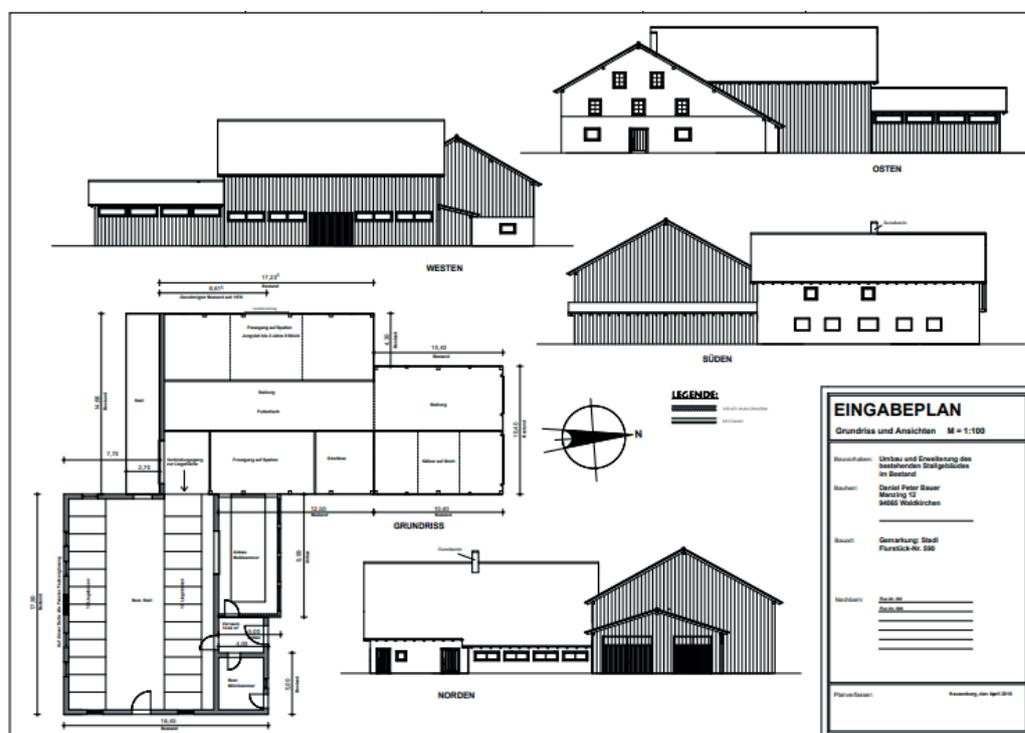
Grundriss und Ansichten des umgebauten Anbindestalls für Milchvieh und bestehenden Stalls für Jungvieh, Kälber und Kalbinnenmast am Betrieb Bauer
